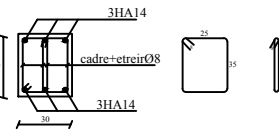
Ferrailage aux appuis d'une poutre secondaire
